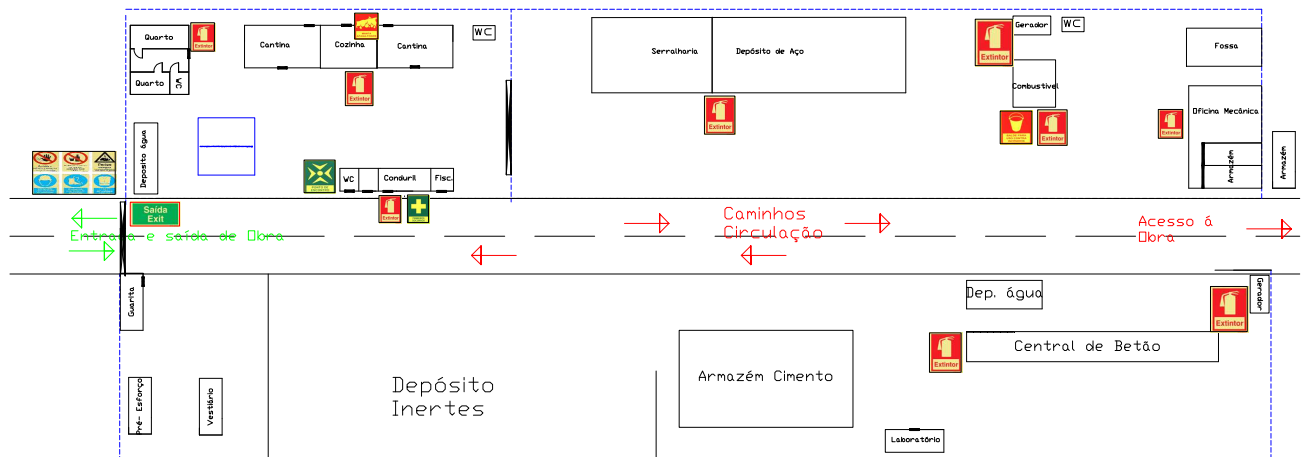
Planta do Estaleiro (Fonte PQO).
